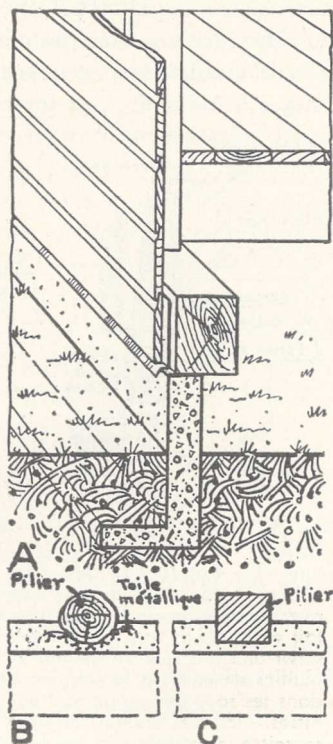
A, mur spécial de béton empêchant les rats de pénétrer dans la maison. Ce mur ne supporte pas l'édifice. B, plan de mur avec supports en bois; le béton est fixé aux piliers au moyen de grillage métallique. C, plan de support en maçonnerie; le béton adhère à la maçonnerie si la surface est bouchardée.
